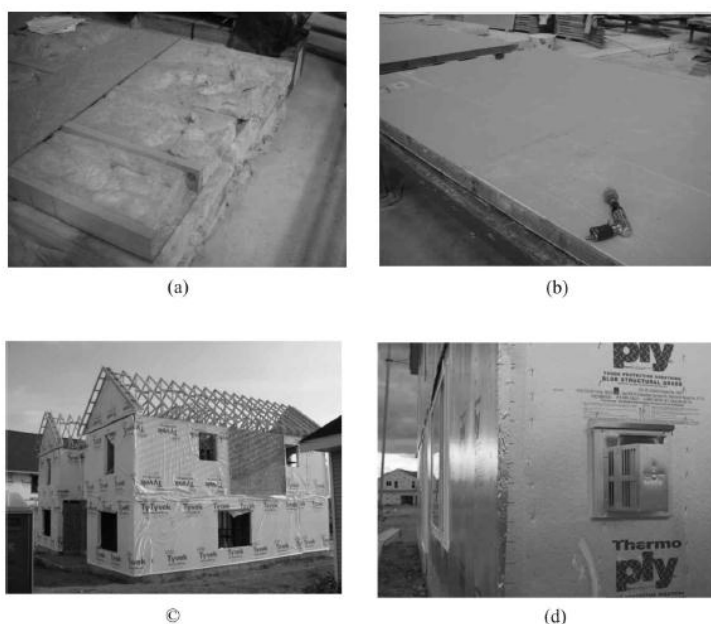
Exemplo de revestimento e preenchimento dos painéis. (a) Lã de vidro interna; (b) Massa cimentícia; (c) Revestimento tipo TYVEK para barreira hidráulica; (d) Isolante térmico. Fonte: Molina e Calil Junior (2010)
